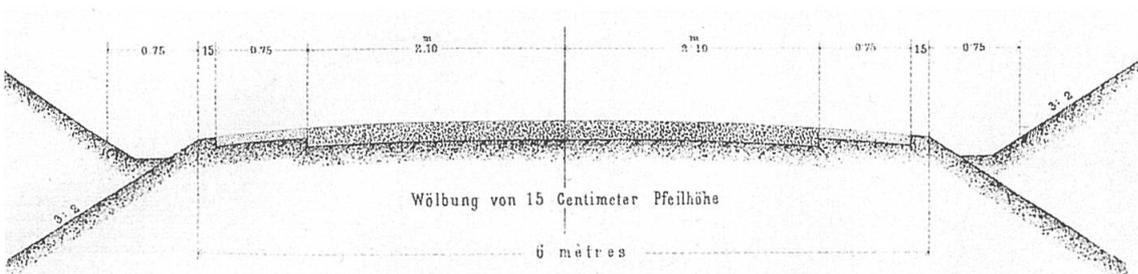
Querprofil einer Waadtländer Strasse nach Simeon Bavier 1878. Im Kanton Waadt waren solche Strassen seit ungefähr 1820 üblich. Die Fahrbahn besteht aus einer einzigen Schotterschicht (Methode von MacAdam). Quelle: Bavier 1878.
